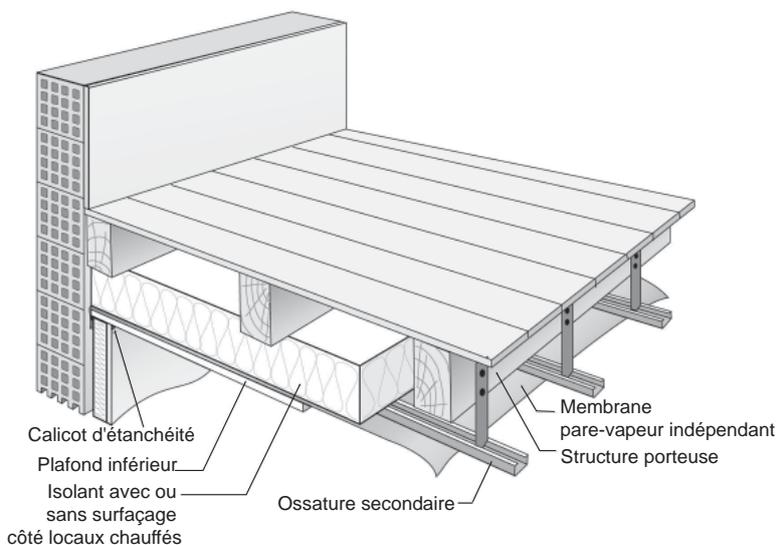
Isolation en combles sur plancher bois: pose interdite
